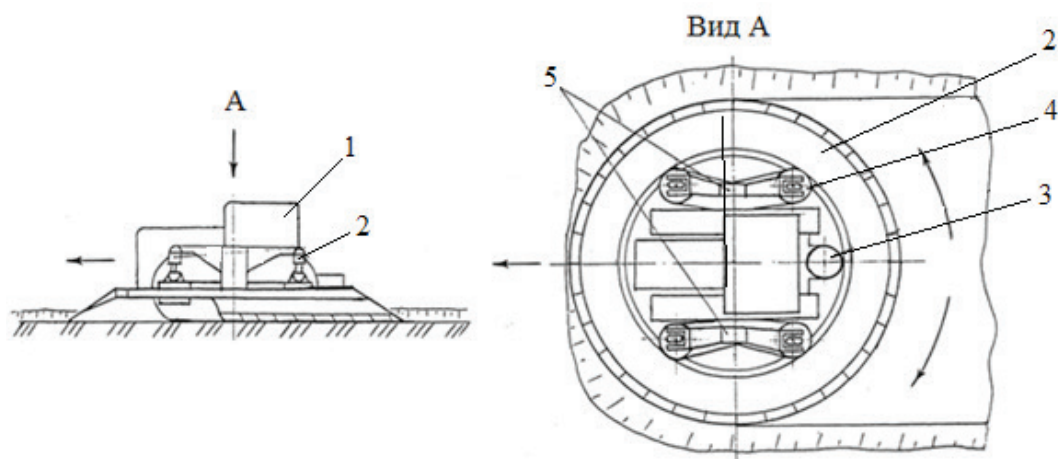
Планировочная машина: 1 – трактор; 2 – двухдисковый кольцевой рабочий орган; 3 – привод; 4 – направляющий ролик; 5 – рама.
